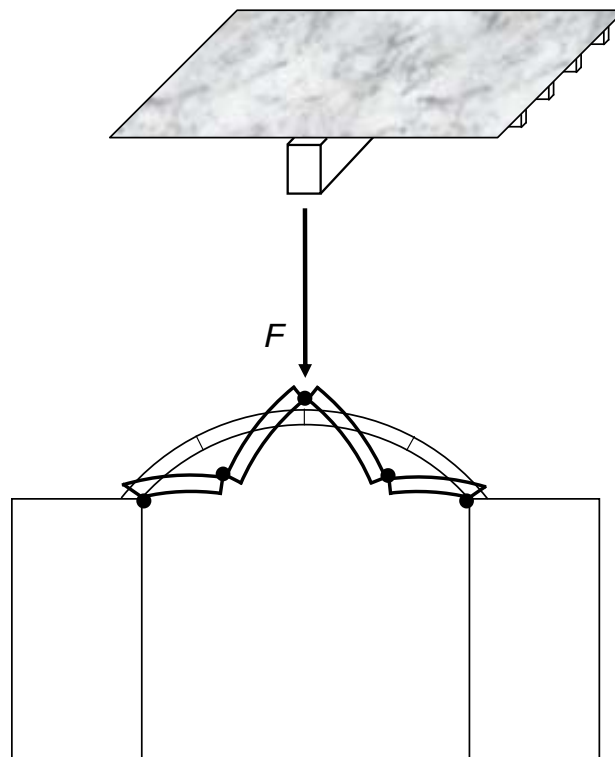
f. La reazione del solaio ai carichi permanenti e ai sovraccarichi accidentali consiste nella forza concentrata F scaricata dalla trave sull'estradosso della chiave. Tale forza è applicata nel punto cui il meccanismo fa compiere il massimo innalzamento. Questo solaio rappresenta quindi un ente resistente, precisamente la tipologia maggiormente resistente per la struttura che lo porta. Questa tipologia di solaio interdice quello che altrimenti sarebbe il meccanismo cogente. Per contro, questa tipologia comporta la massima spinta all'imposta, al punto da poter invertire la gerarchia delle resistenze.
